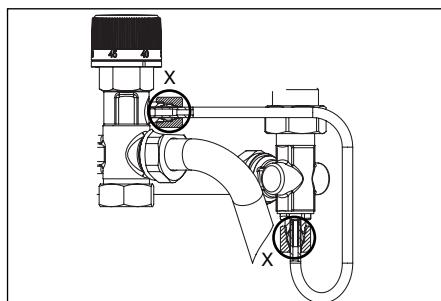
Darstellung Einbau 1341271 / 1341274
